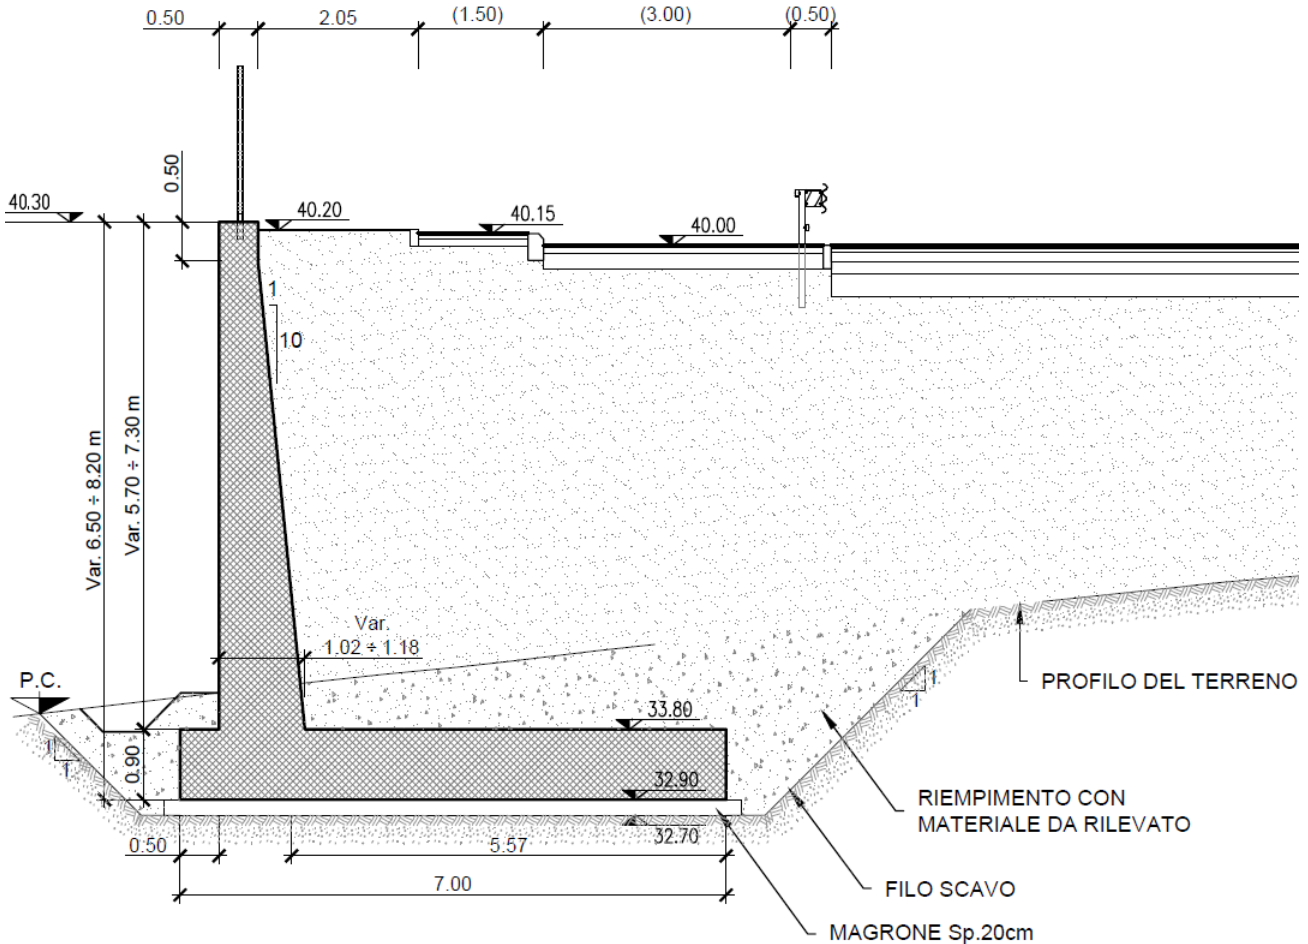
Sezione trasversale Muro Tipo 2 - Piazzale FV01.
